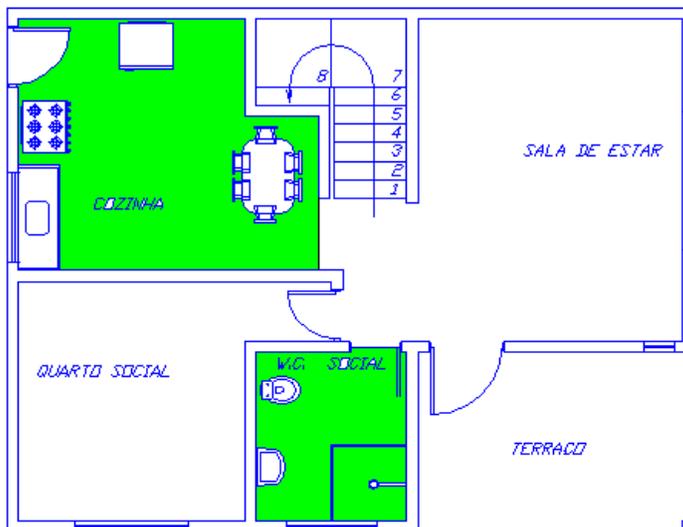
Exemplo de Planta Baixa e ÁREAS MOLHADAS.
